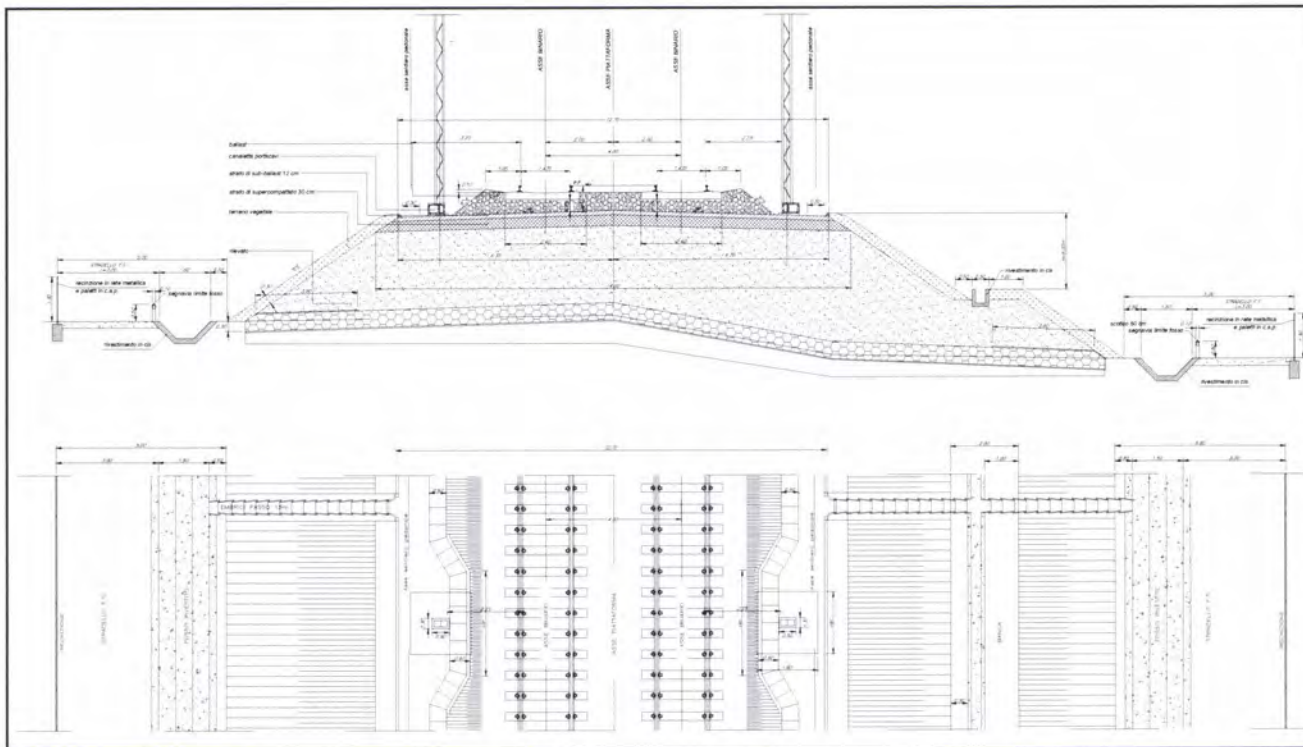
Sezione Tipo doppio binario in Rilevato - senza Barriere Antirumore -
